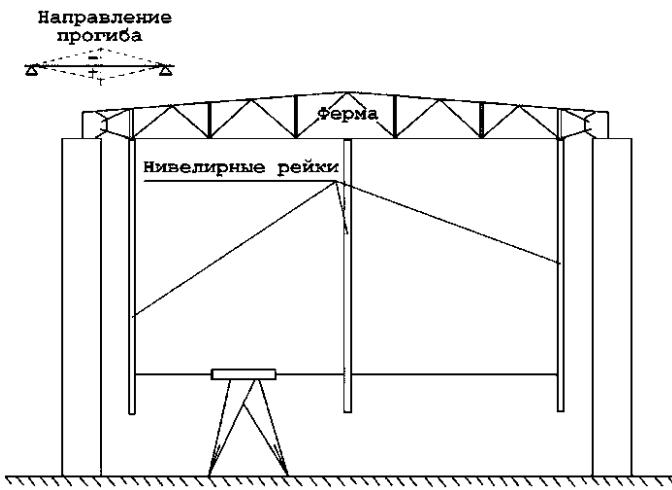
Исполнительная съемка фактических прогибов ферм перекрытия методом геометрического нивелирования
